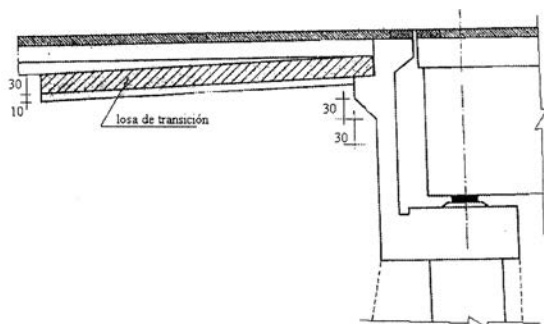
Emplazamiento de la losa de transición [10], caso de pavimentos flexibles.
